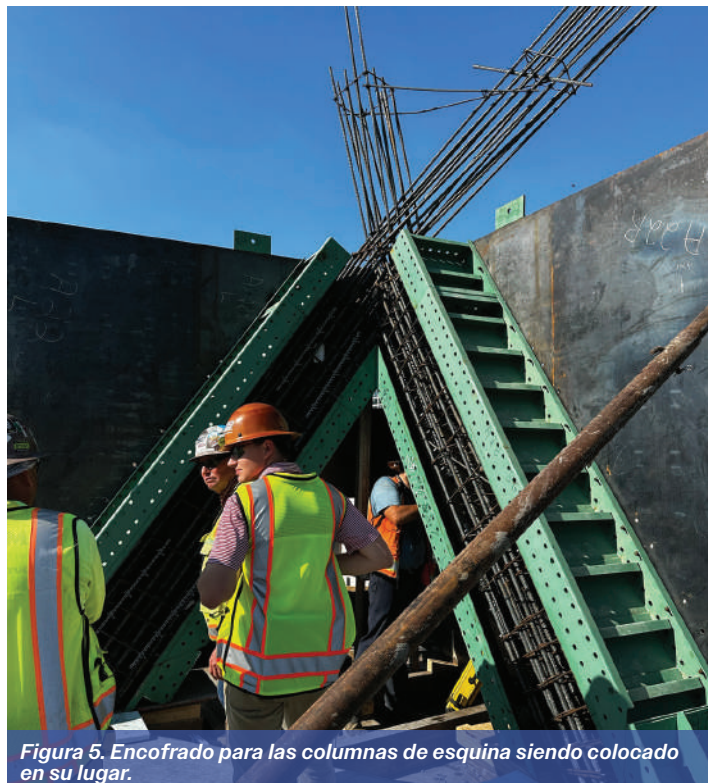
Encofrado para las columnas de esquina siendo colocado en su lugar.
